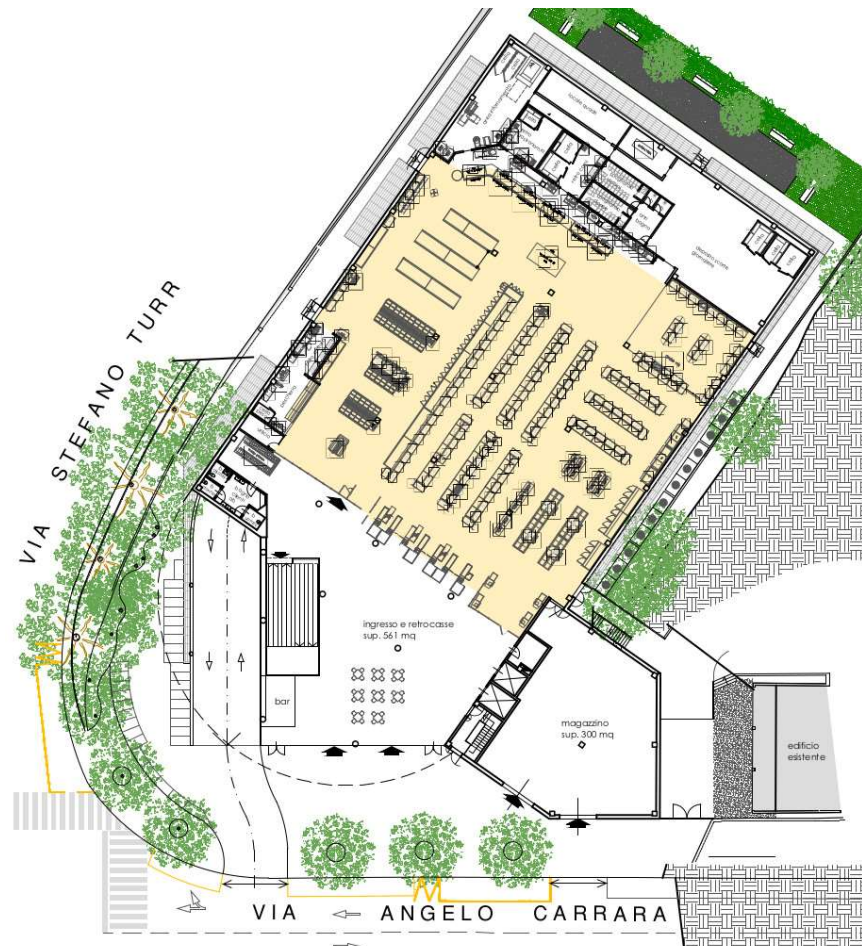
Pianta piano terra di progetto, in giallo la MSV, 1500 mq.
